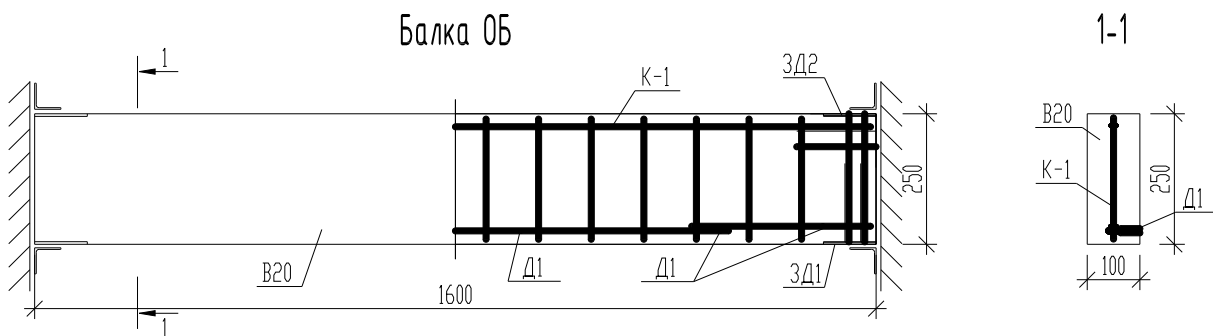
Схемы опалубки и армирования опытного образца железобетонной балки ОБ
